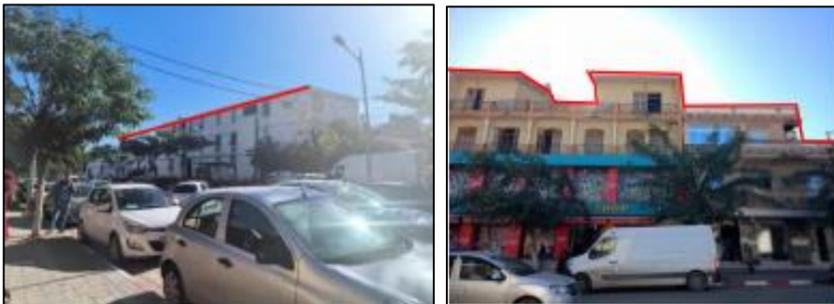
Façades rythmées horizontalement. Crédit : auteur, éditées par l'ensemble du groupe.
